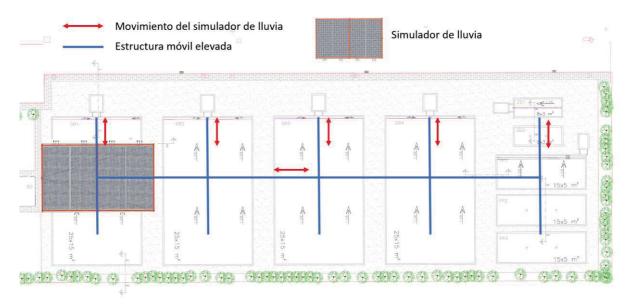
Esquema B de posible solución planta del simulador de lluvia y la estructura móvil
